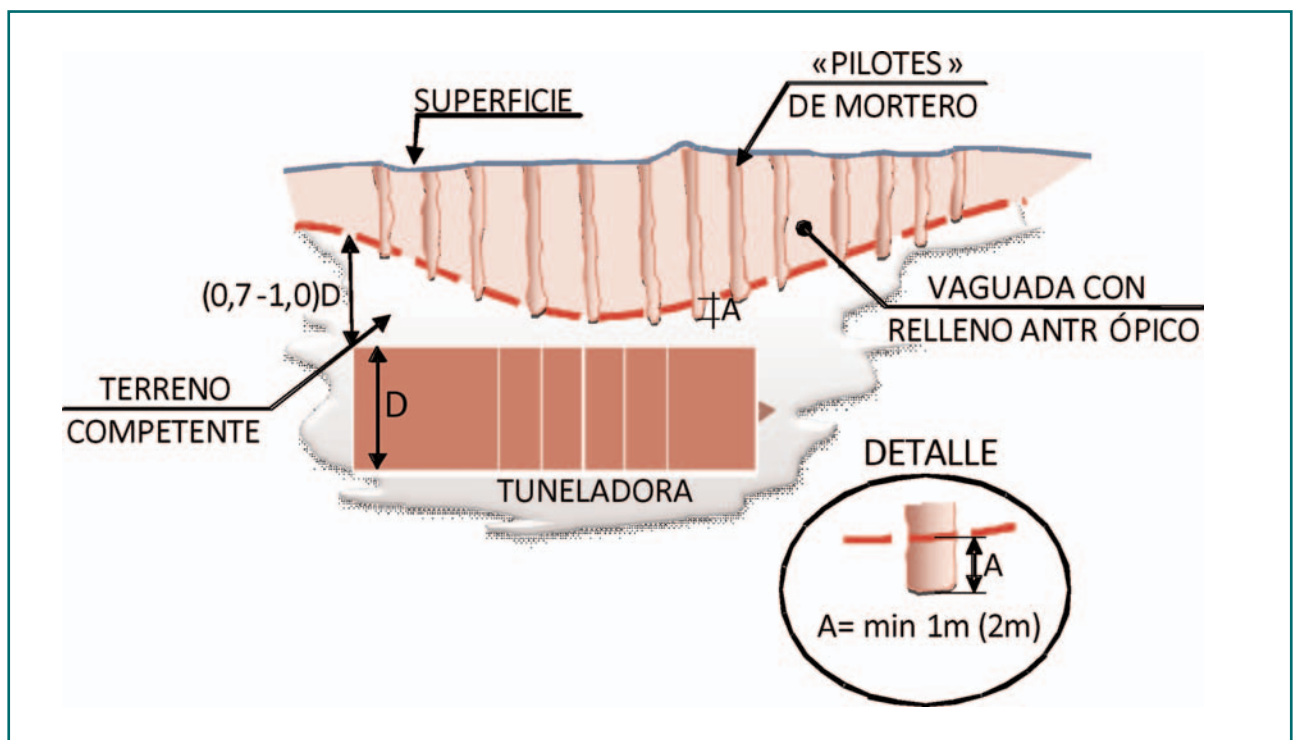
Refuerzo de rellenos con columnas de mortero.
